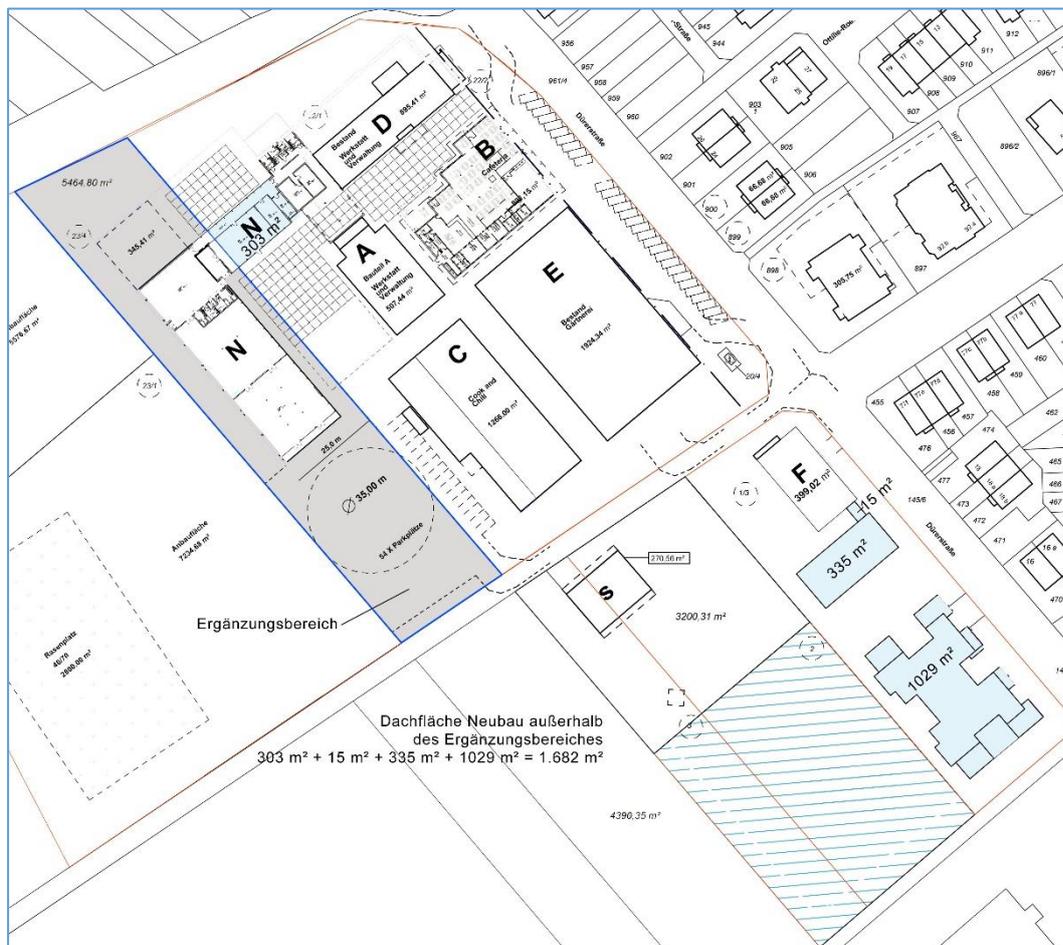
Dachflächen geplanter Neubau außerhalb des Ergänzungsbereichs (ohne Maßstab)
